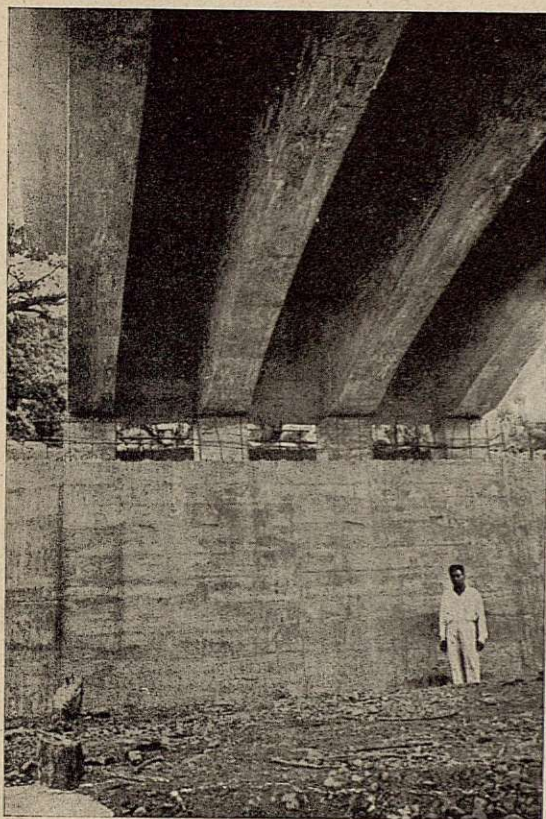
Aparatos de apoyo pendulares del tramo de 23 metros sobre la pila del lado de Girardot.
